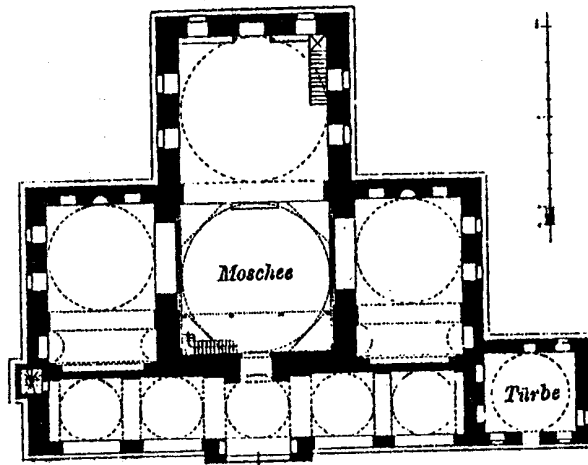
مسقط أفقي لجامع اورخان غازي في بورصة (أوبروسه) (عن : Kuran)
